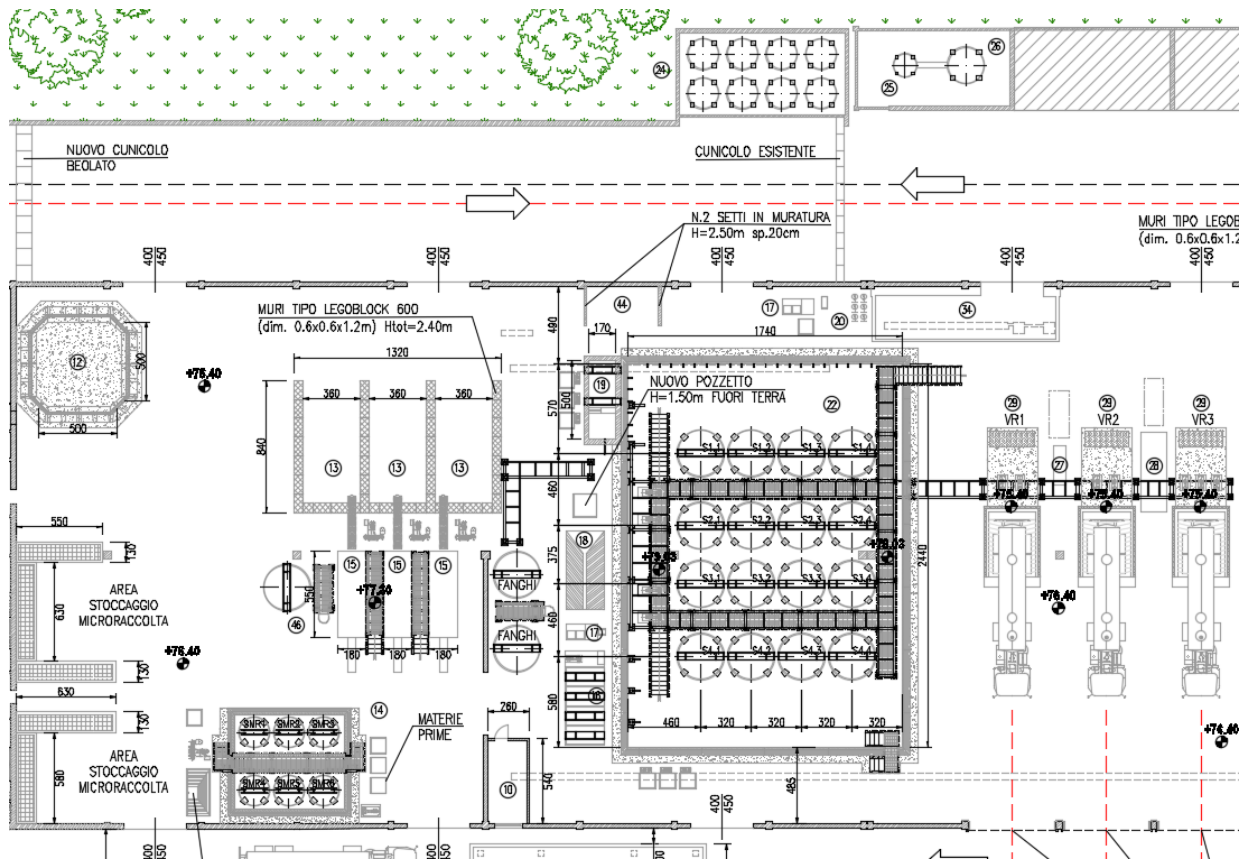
vista planimetrica impianto trattamento chimico/fisico
